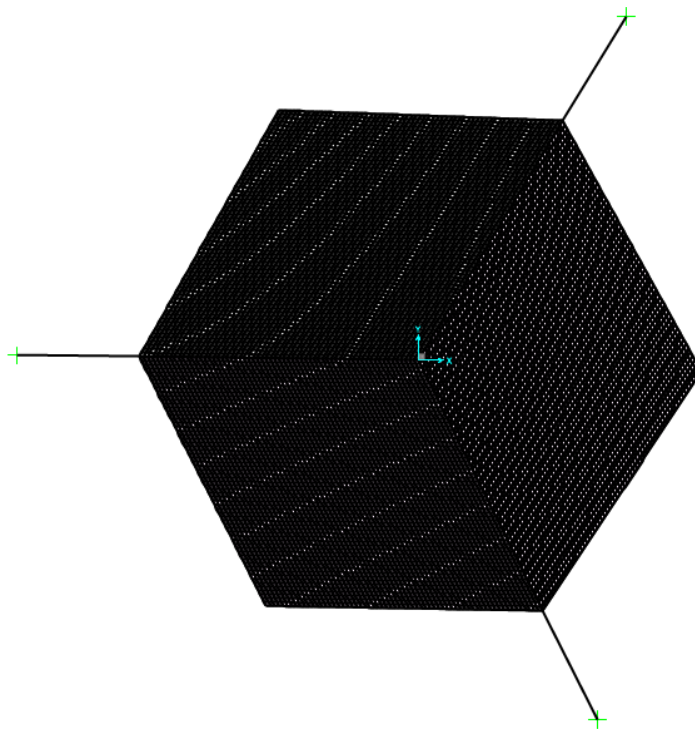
Vista del modelo estructural - Plano XY con apertura o grados
